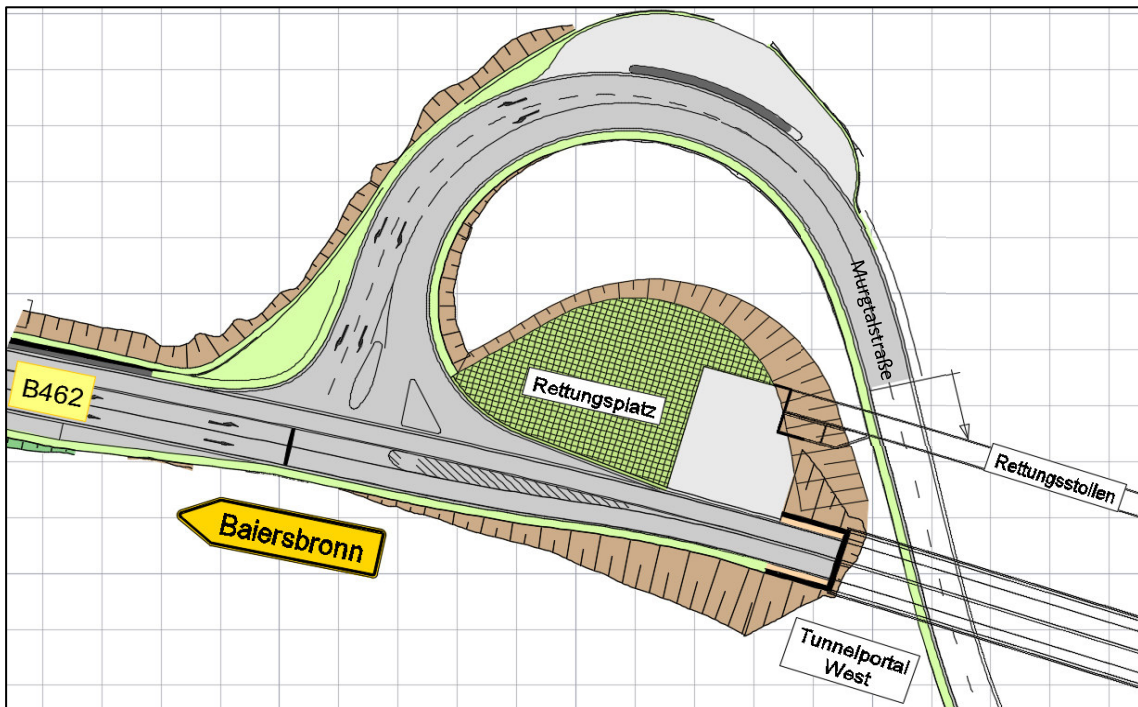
Knotenpunkt West (B 462) mit Tunnelportal West (Fahrtrichtung Baiersbronn)
